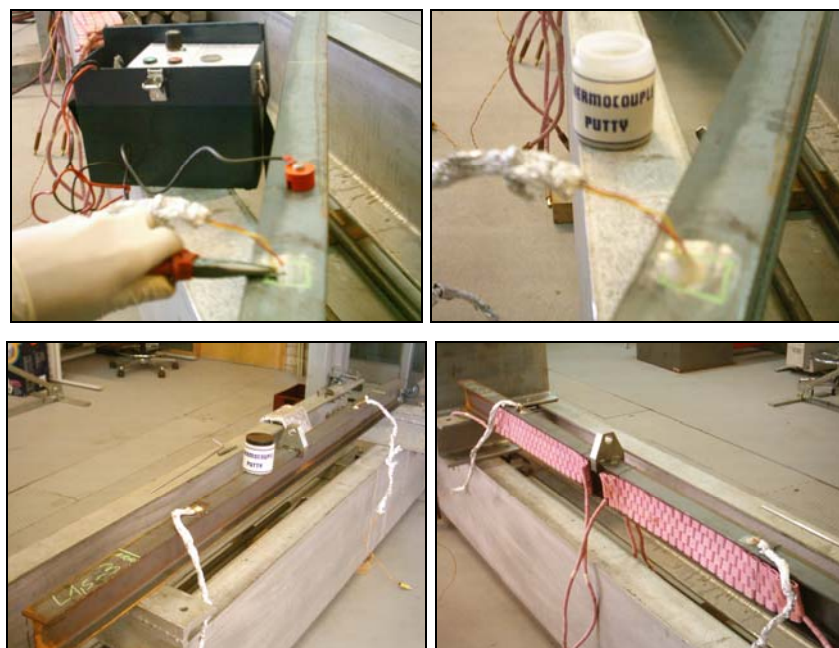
Soldadura e protecção dos termopares.
